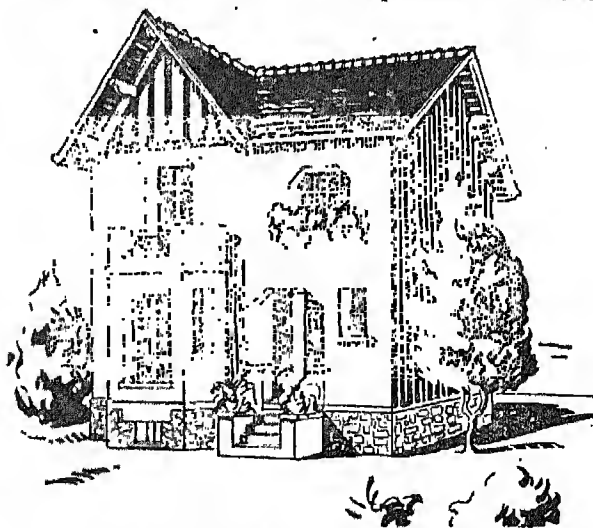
Maison moderne, à la campagne. L'air circule librement tout autour. Comment est-elle exposée (consultez les plans du rez-de-chaussée et de l'étage, fig. 3).
